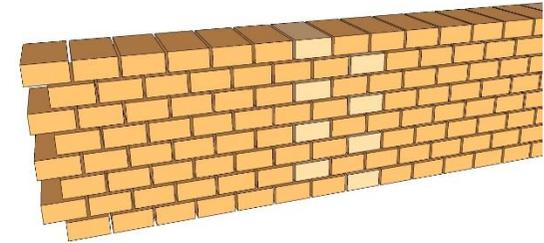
Aparejo tipo tizón, Fuente: elaboración propia
